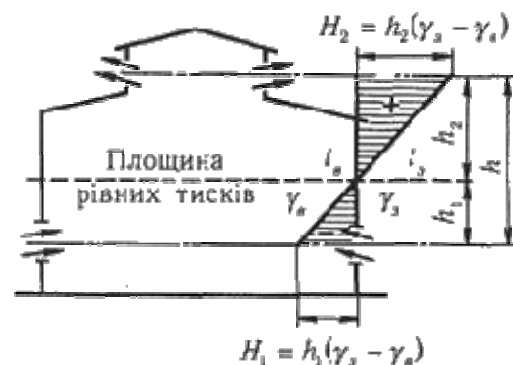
Розподіл тиску повітря у будівлі внаслідок дії теплового напору
